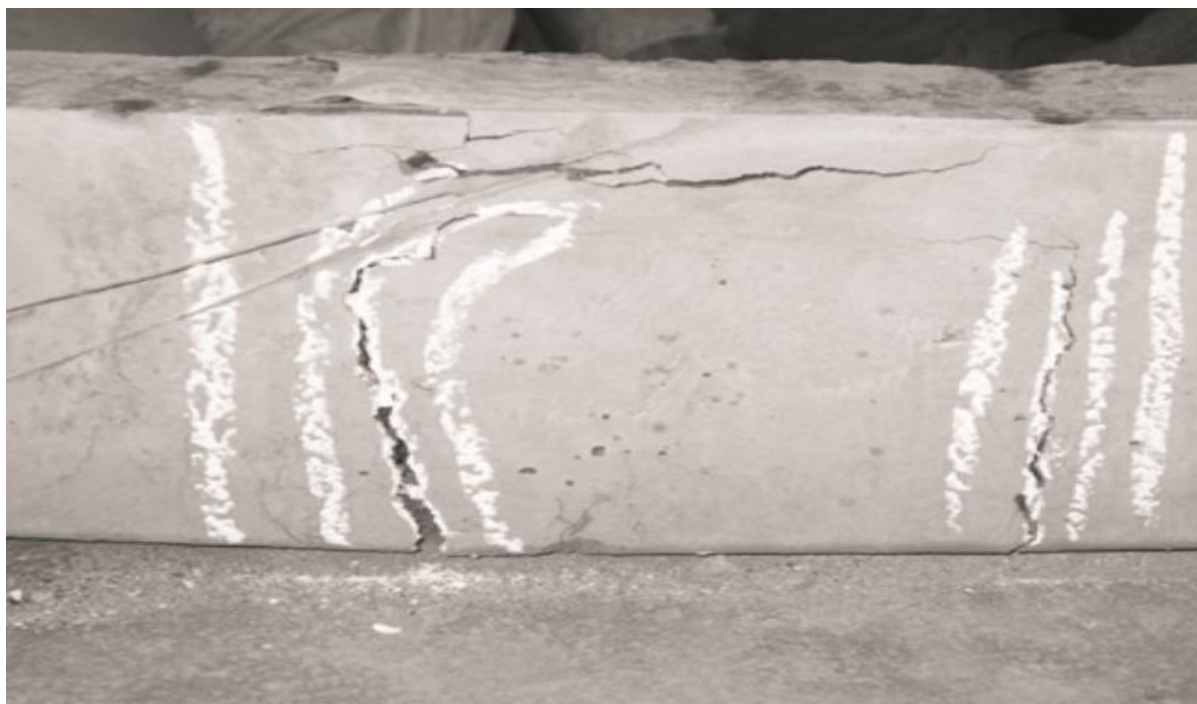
Trau T4- detaj i këputjes së shufrave GFRP dhe shkatërrimit të traut në zonën e shtypur të betonit
